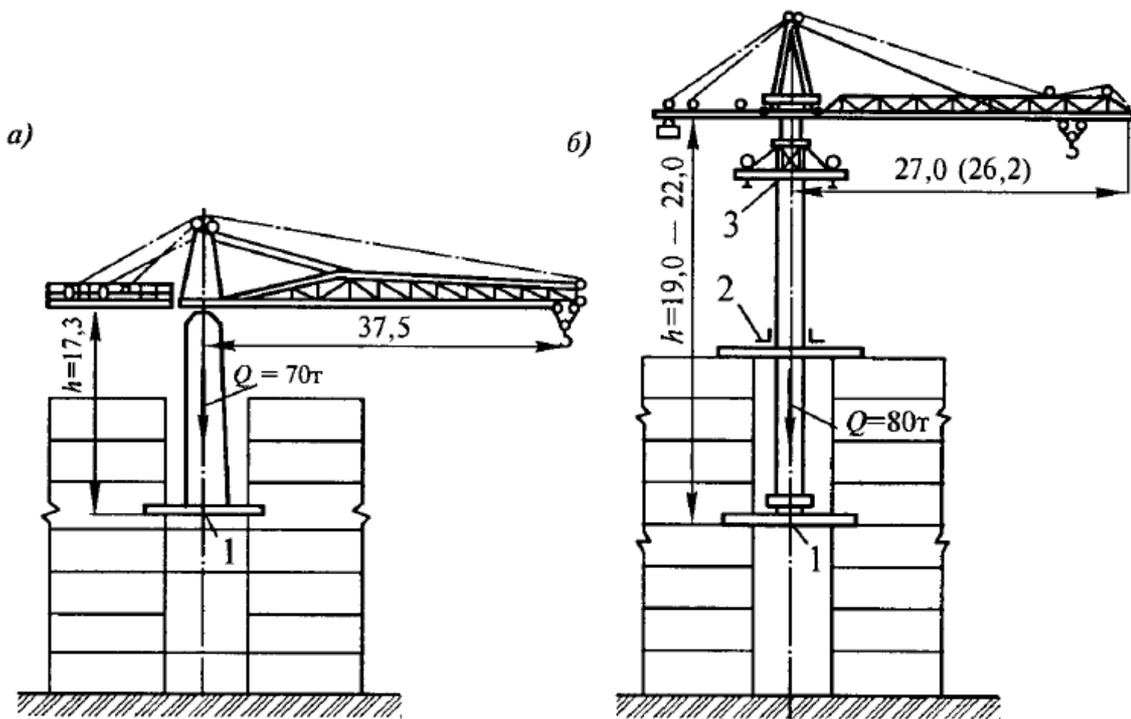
Схемы самоподъемных кранов для монтажа высотных зданий:
